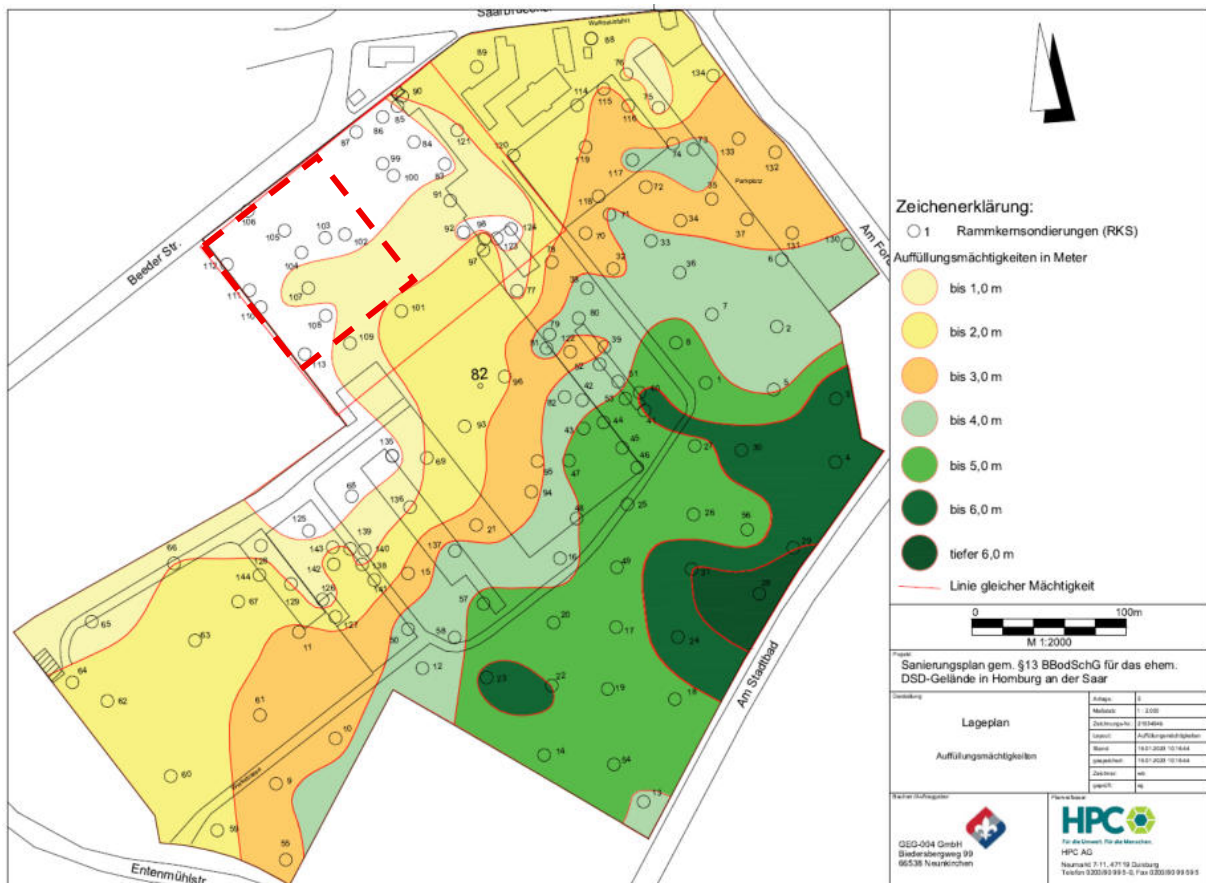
Lageplan aus den Rammkernsondierungen ermittelten Auffüllungsmächtigkeiten (COEUR-Gelände = rot gestrichelt) (Quelle Sanierungsplan HPC [5])
